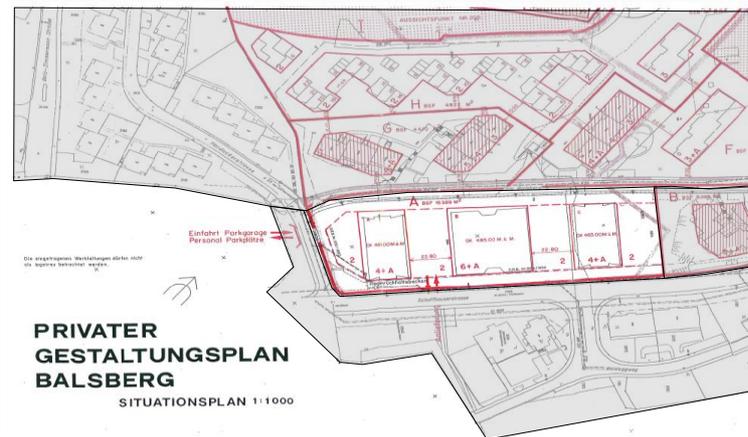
1989 revidierter Privater Gestaltungsplan Balsberg
